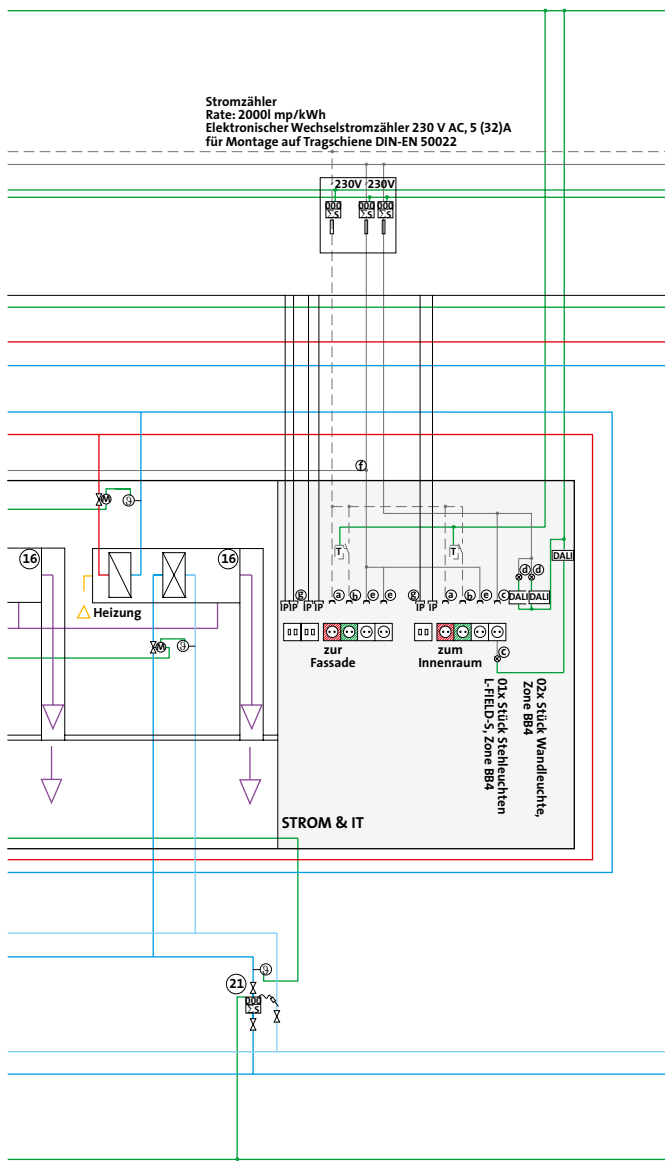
Ausschnitt aus dem Gesamtschema des future:workspace
